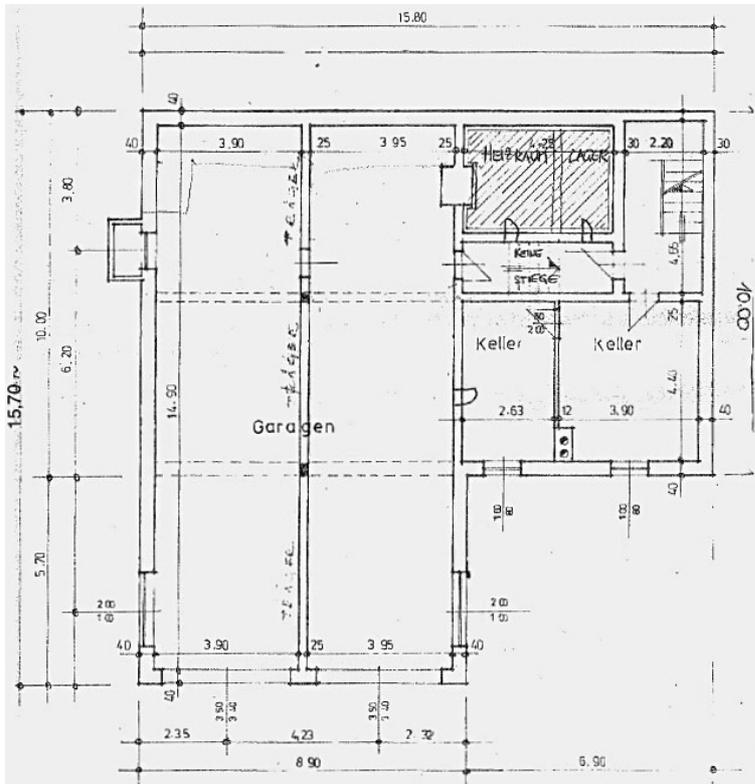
Grundriss 1. Untergeschoss Bestand [47]
